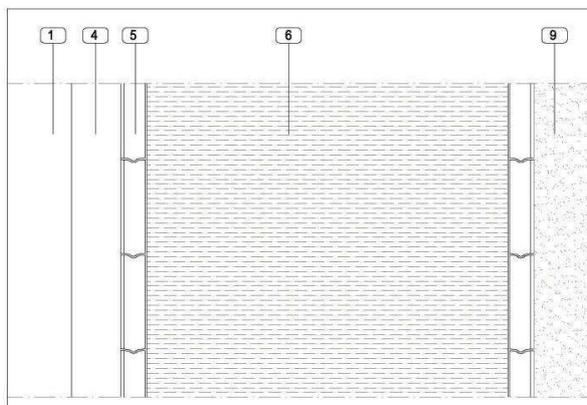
pianta pista ciclabile con pavimentazione in asfalto pigmentato
